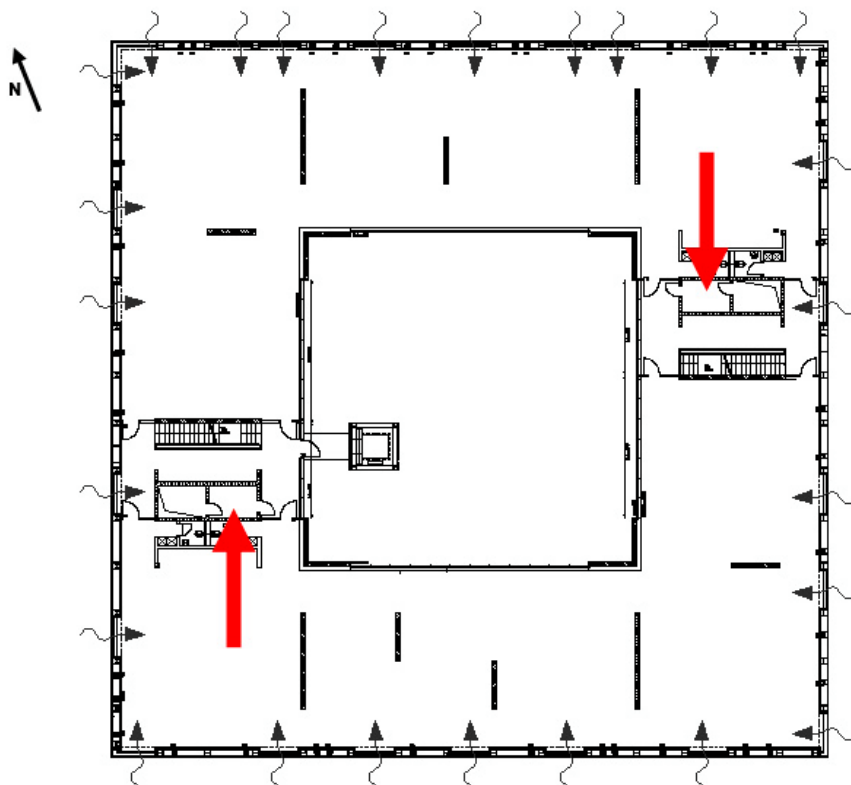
Grundriss 1.OG mit Darstellung der Luftführung
